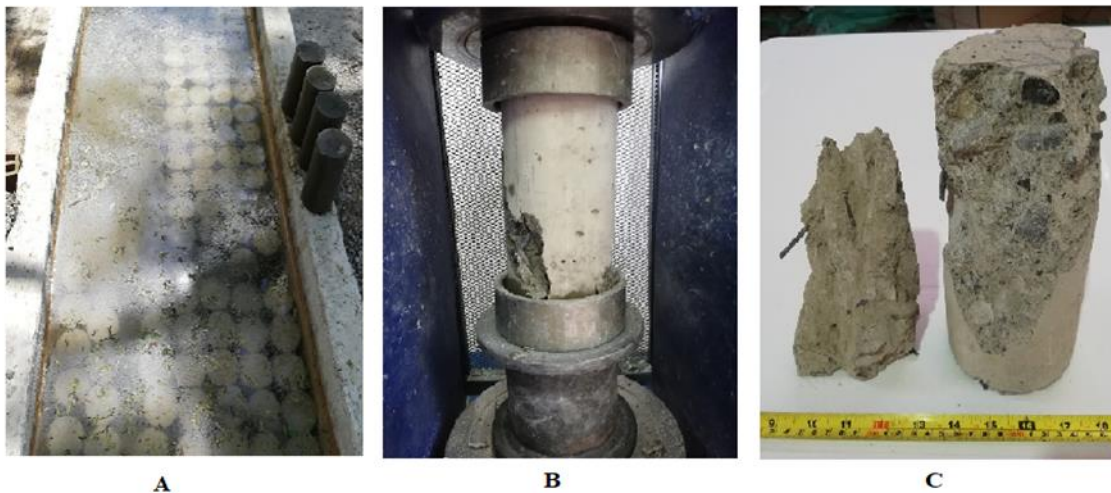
Piscina de curado de cilindros de prueba a compresión (A), cilindro sometido a ensayo de compresión (B), cilindro reforzado con macro fibra LDPE-R, fallada.
